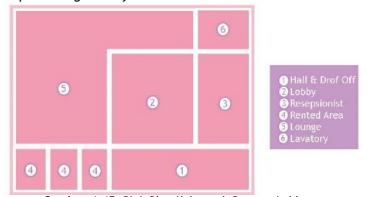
Blok Plan Kelompok Ruang - Konvensi (Meeting Room) (Sumber: Analisis, 2020)
